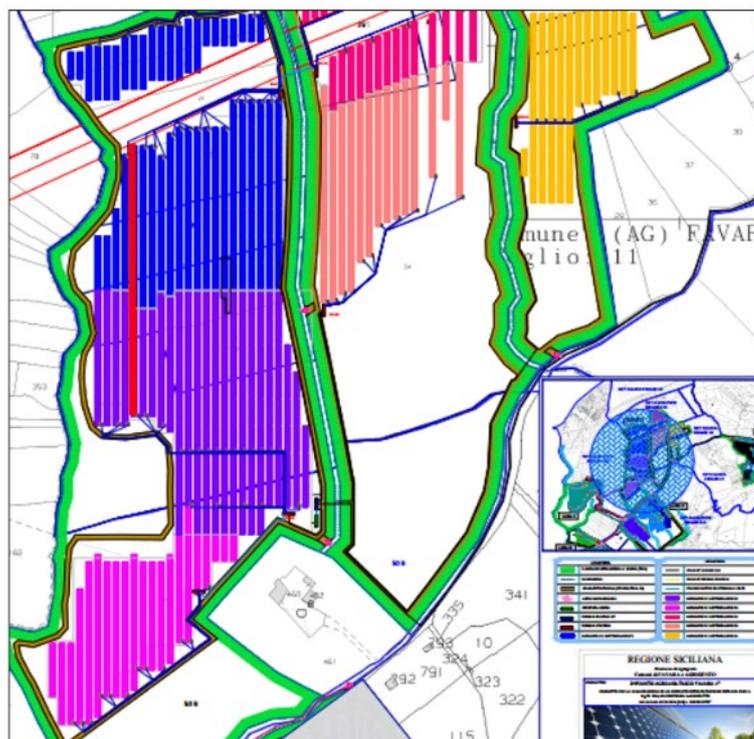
lotto F (Profilo: linea rossa direzione Nord-Sud)
